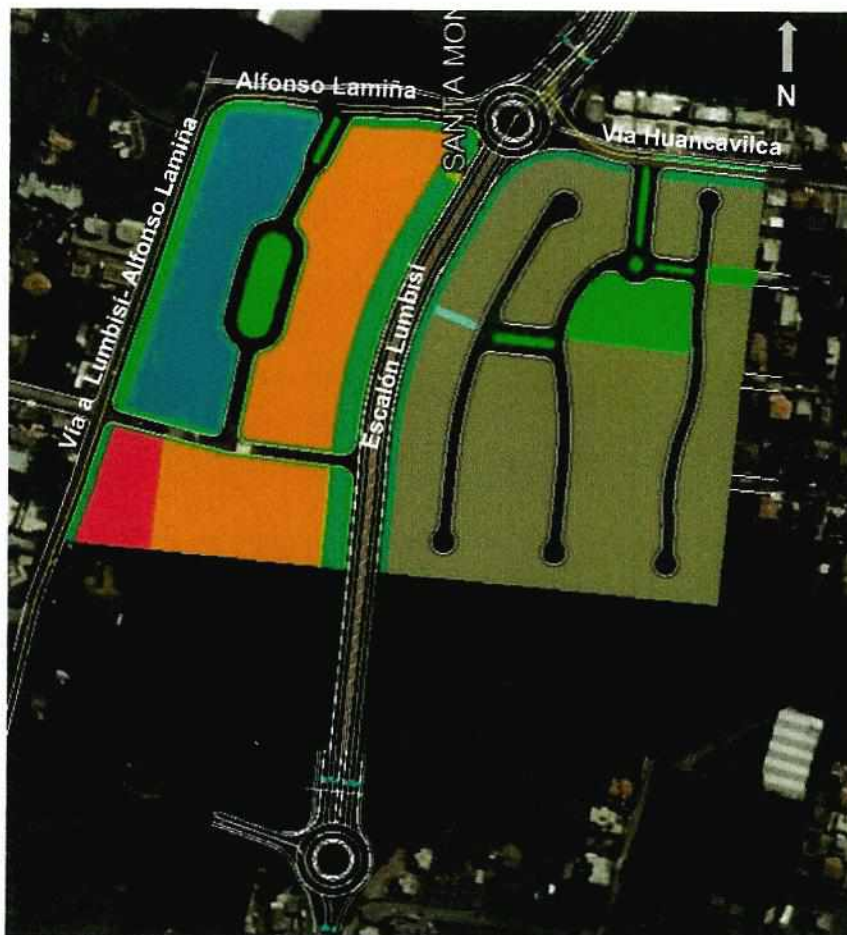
Propuesta Implantación proyecto presentado en mayo 2018
